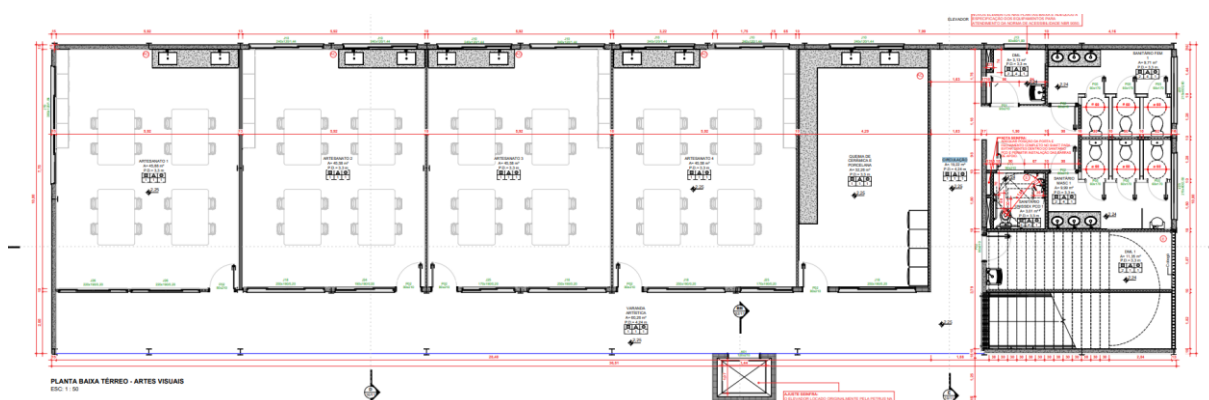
Planta Baixa Térreo – PROJETO ORIGINAL
